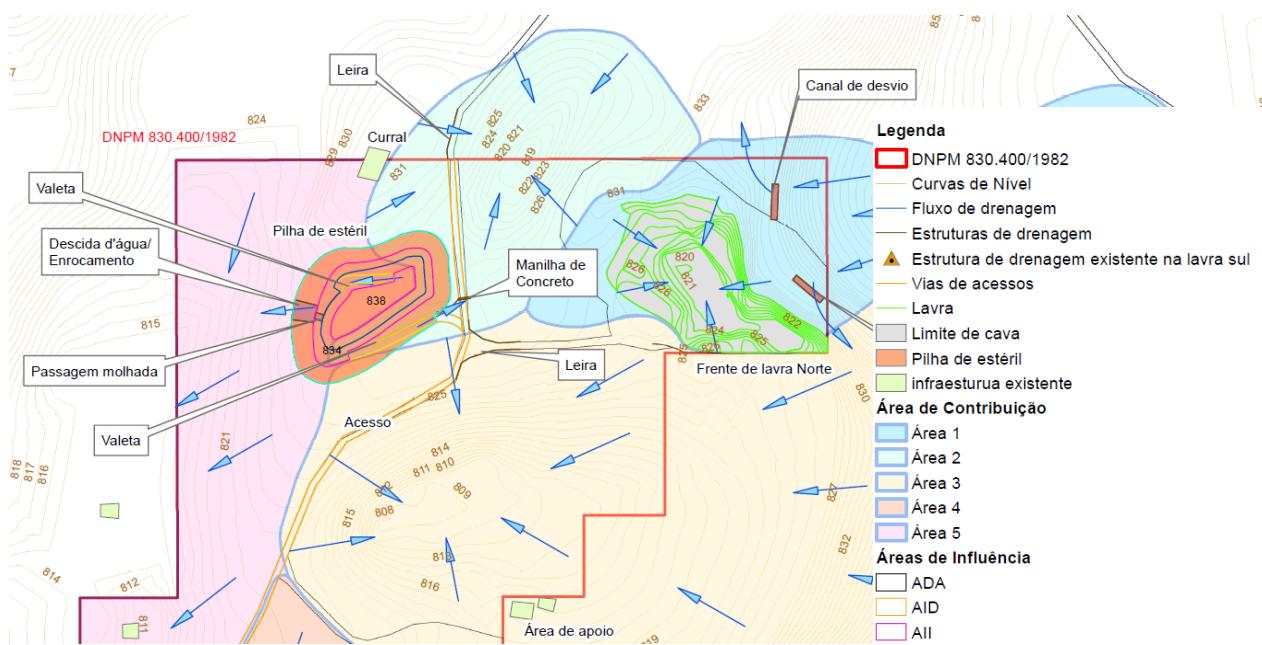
Fluxo de drenagem na área de lavra e local sugerido para escavação dos canais de drenagem.
